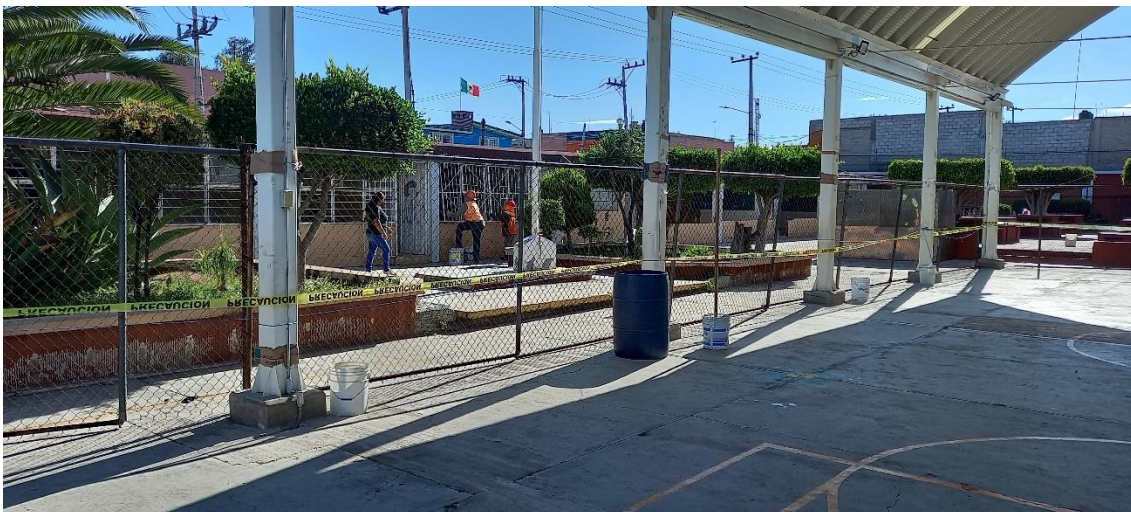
Colocación de protecciones para alumnado de la escuela Ignacio Allende.
